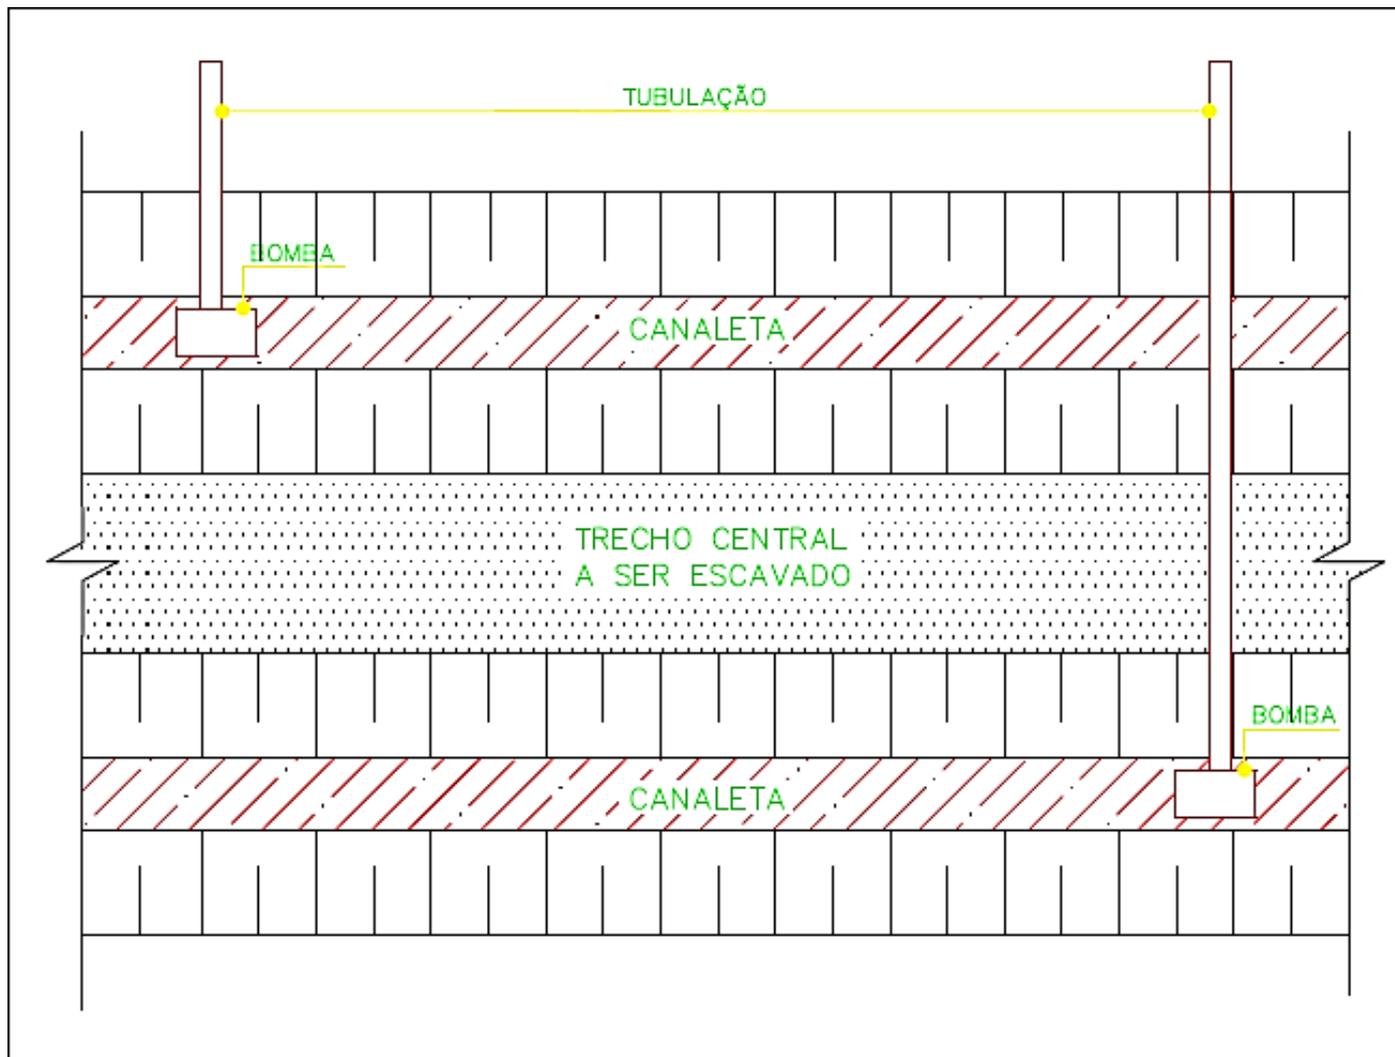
Planta do posicionamento das bombas e valas para rebaixamento do nível d'água
